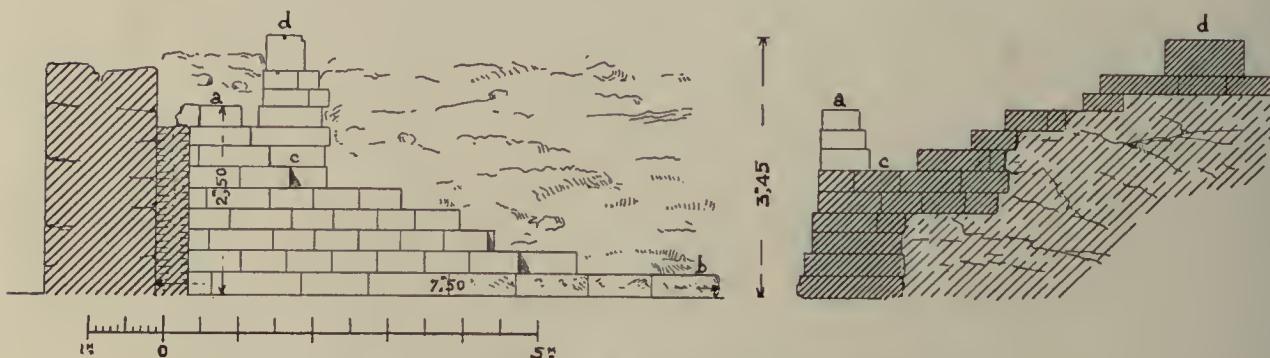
Élevation et coupe des murs contigus au péribole Ouest.
